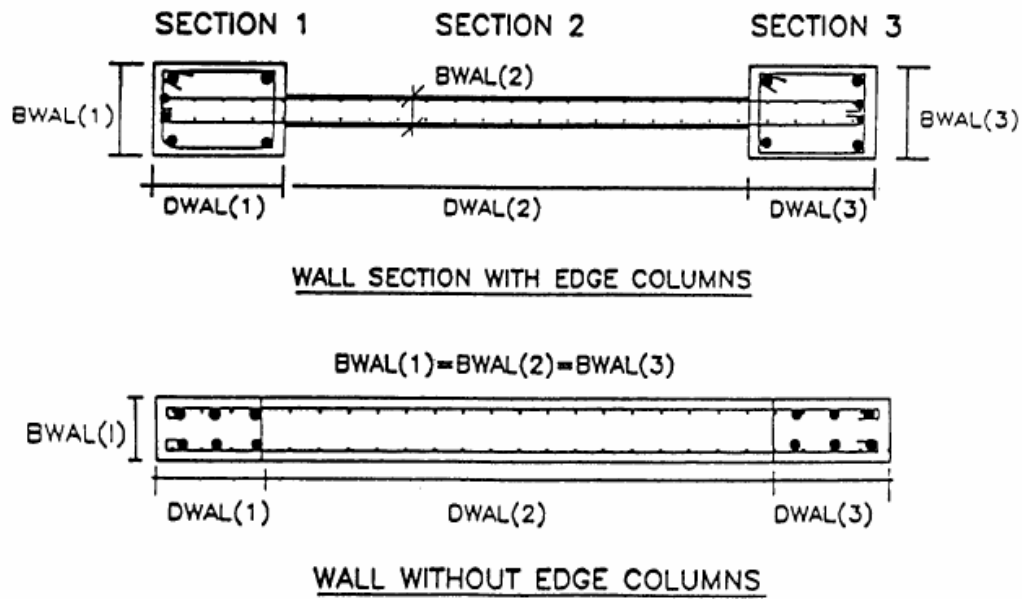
Detalles de entrada típicos para secciones de muros estructurales
